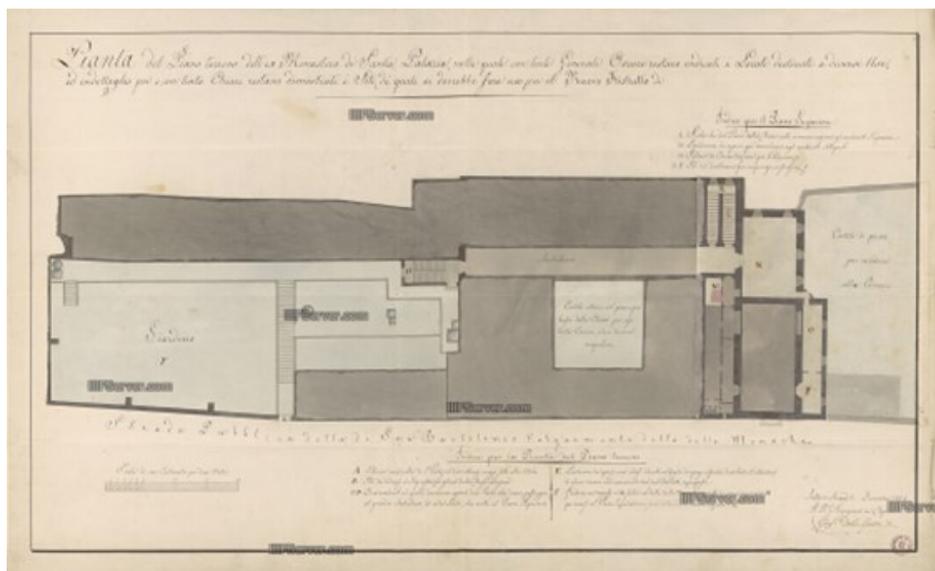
Pianta del piano terreno del Convento di Santa Palazia, Ing. in capo Giuseppe Della Gatta, Ancona Dicembre 1825, Archivio di Stato, Roma
